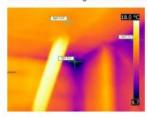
IR-Aufnahme Sangerhäuser Straße 35 Dachgeschosswohnung
